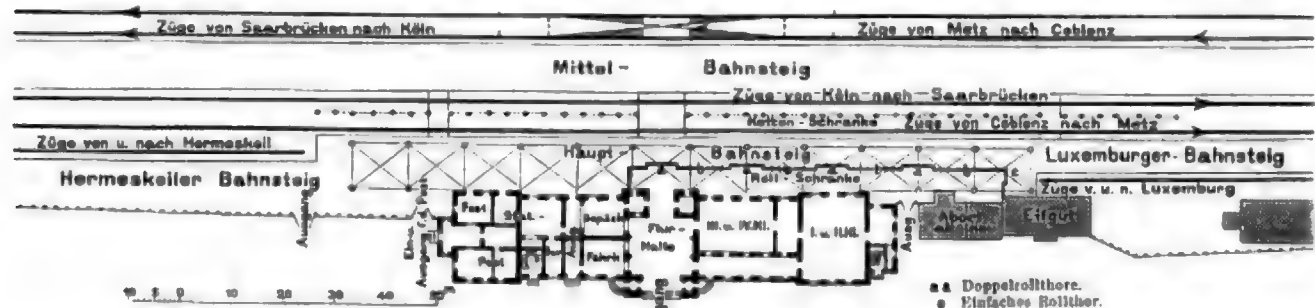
Bahnhof Trier r. M. Lageplan der Bahnsteige usw.
